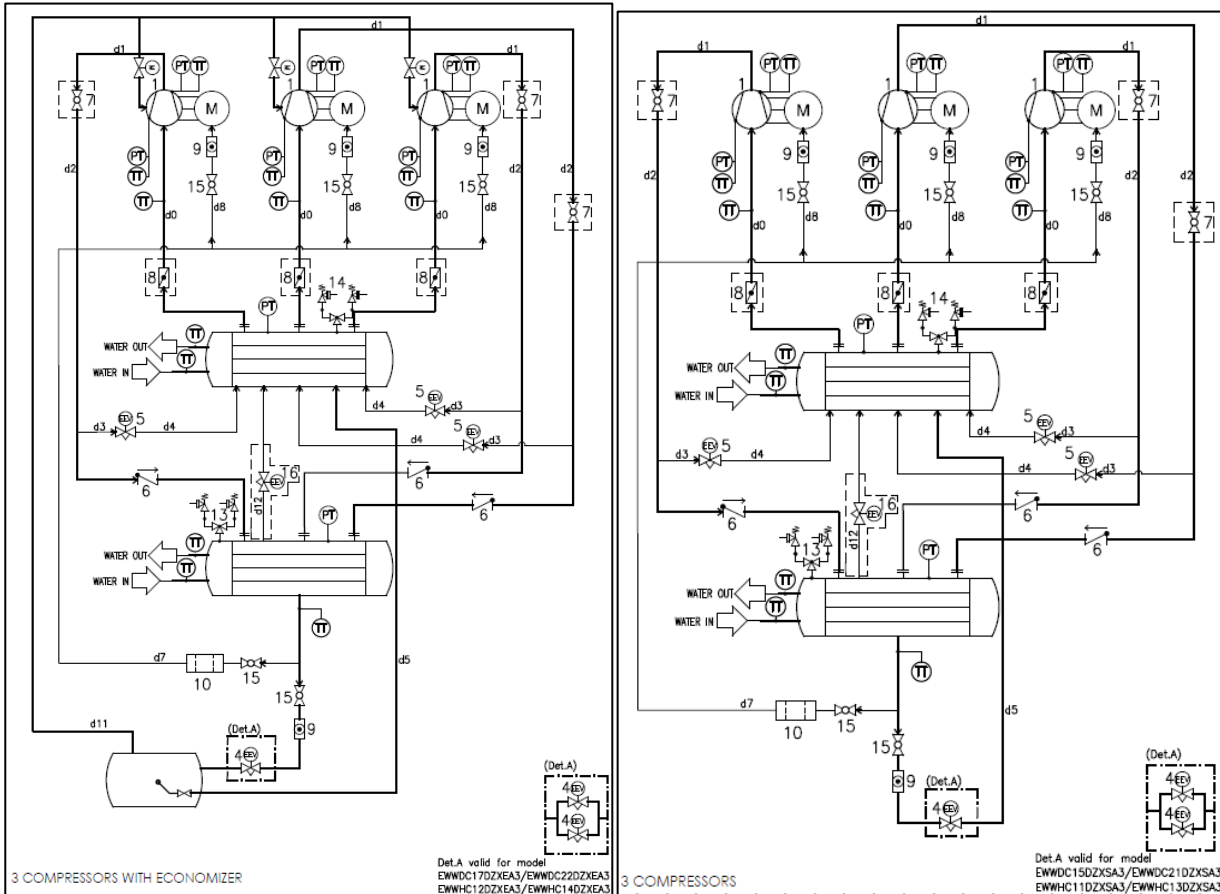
СТИКИП трехкомпрессорного агрегата без экономайзера и с ним
